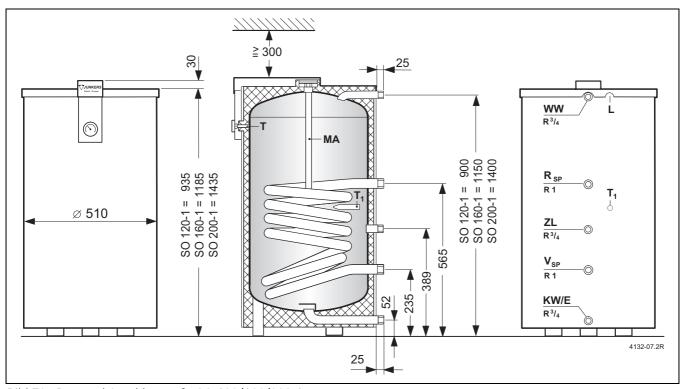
Bau- und Anschlussmaße SO 120/160/200-1
